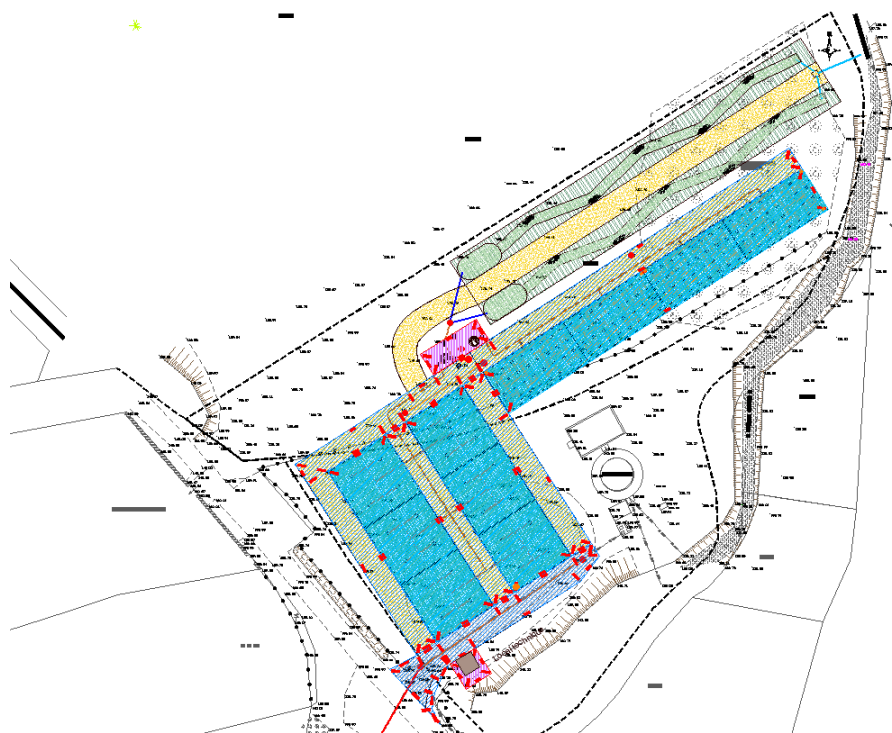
Plan de la station d'épuration au stade PRO – Source : ARTELIA
